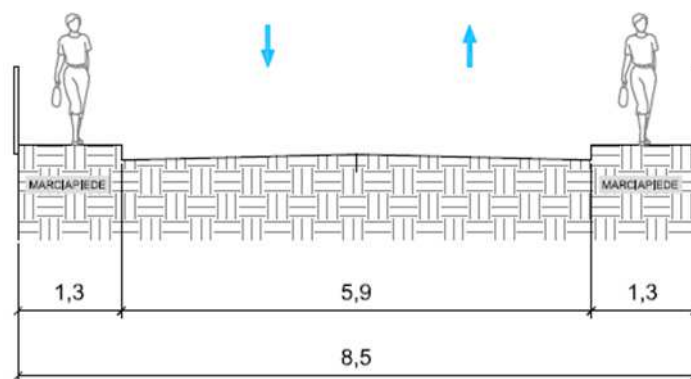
Sezione tipo Ponte Ipazia – stato attuale
